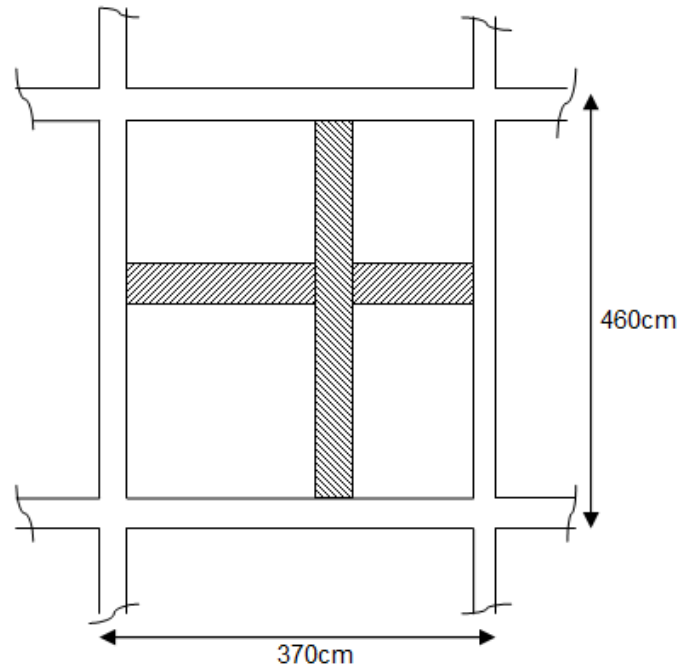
Dimension du panneau de dalle le plus sollicité
